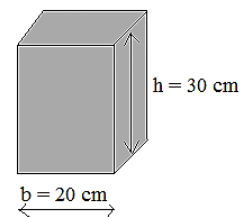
Pré dimensionnement des poutres de chaînage
